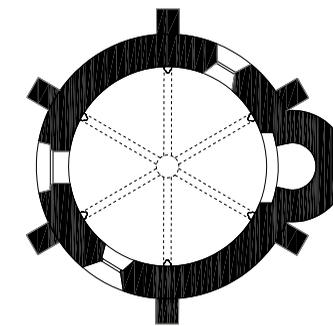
Grundriss St. Agnes, M 1:200, Planarchiv des BDA Wien.
